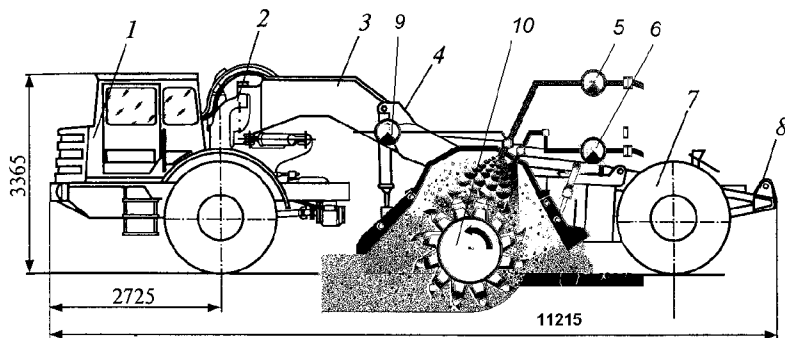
Конструктивная схема рециклера на агрегатах скрепера МоАЗ-6014:
